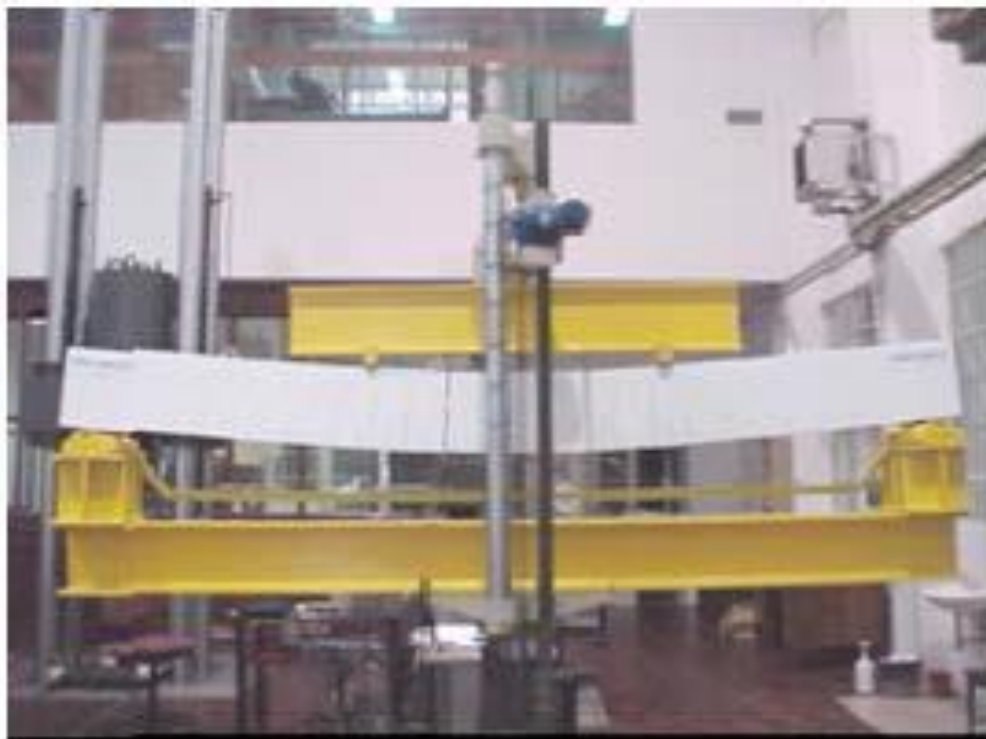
Viga bi apoiada submetida a duas cargas concentradas (Gontijo, 2012).
